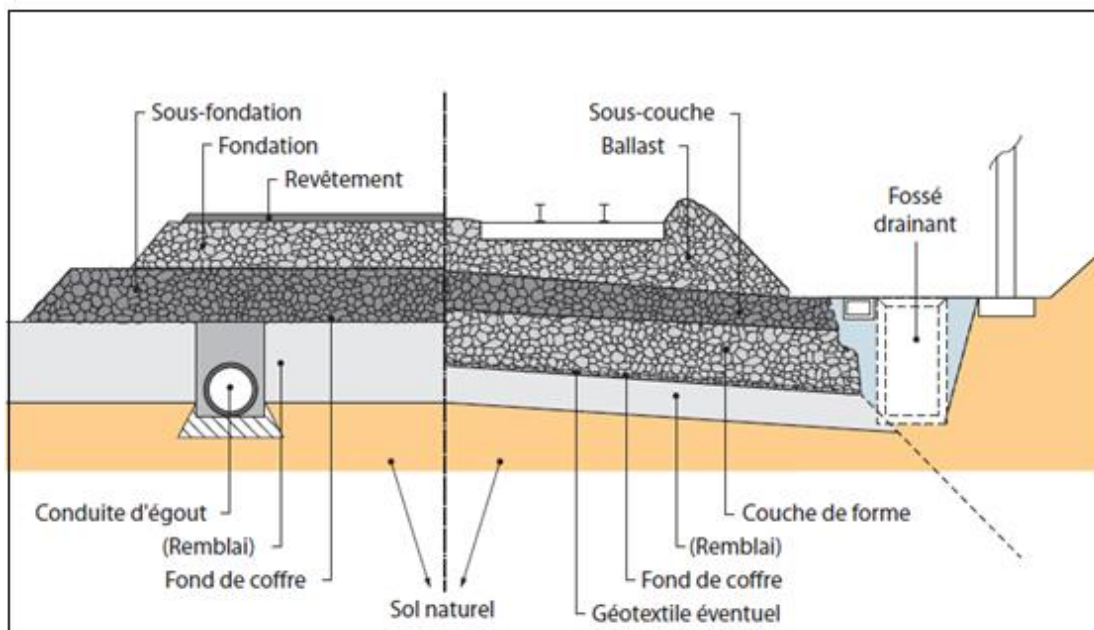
Schéma de structure de chaussée (et voie ferrée).
